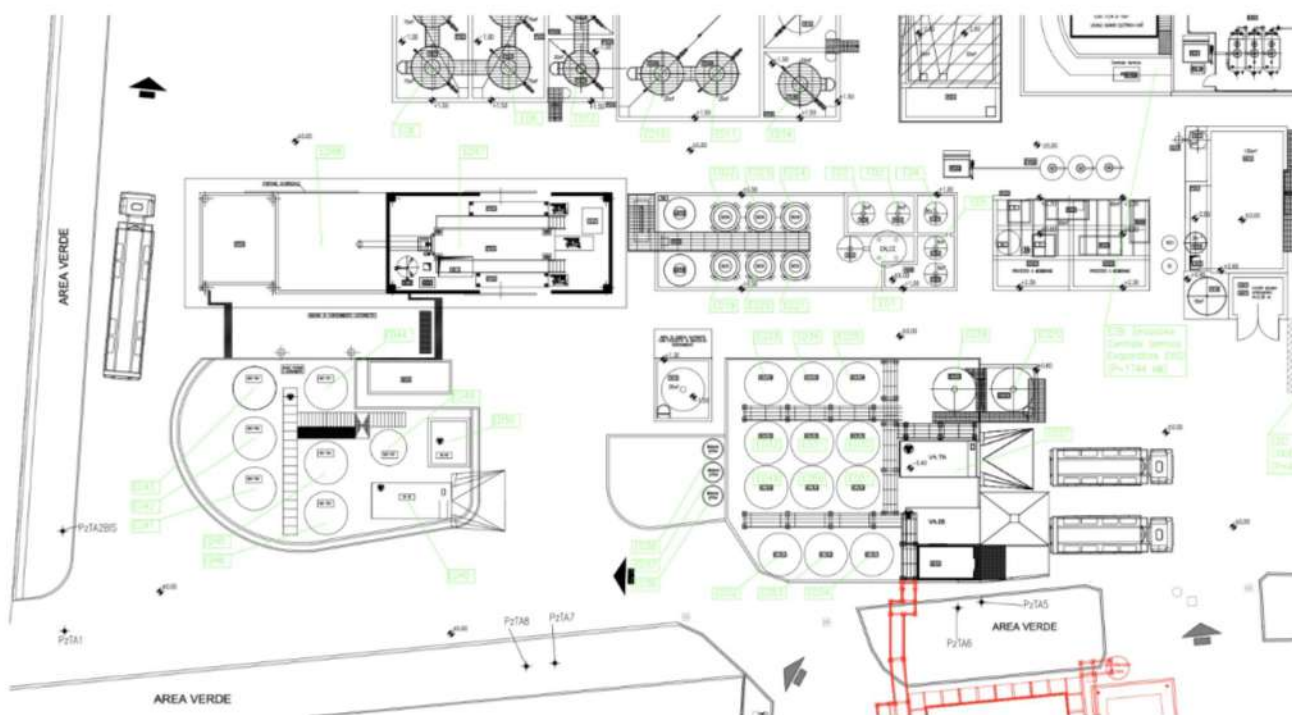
Localizzazione delle sorgenti - estratto planimetria impianto
